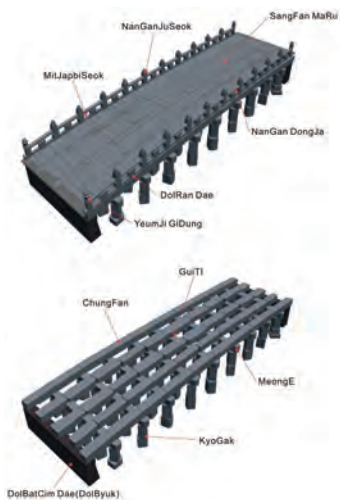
Rappresentazione 3D degli elementi strutturali del ponte
